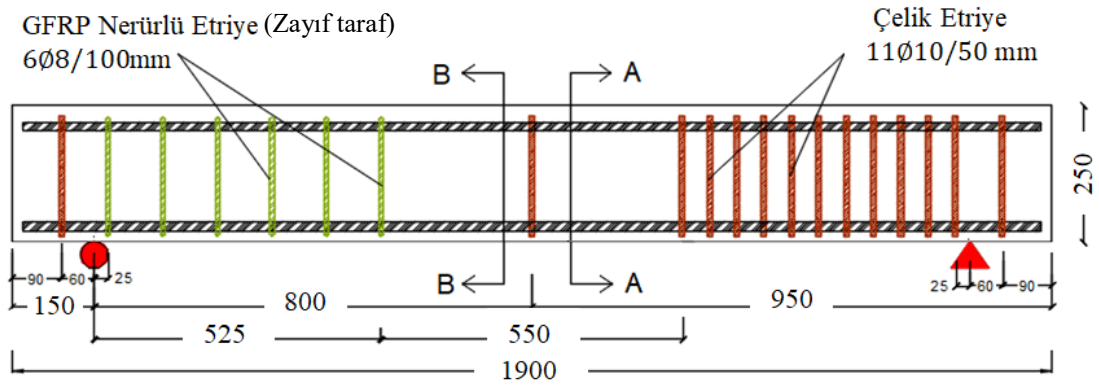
Referans kirişlerin geometrik ebatı ve donatı yerleşim planı (Ebatlar mm'dir)
